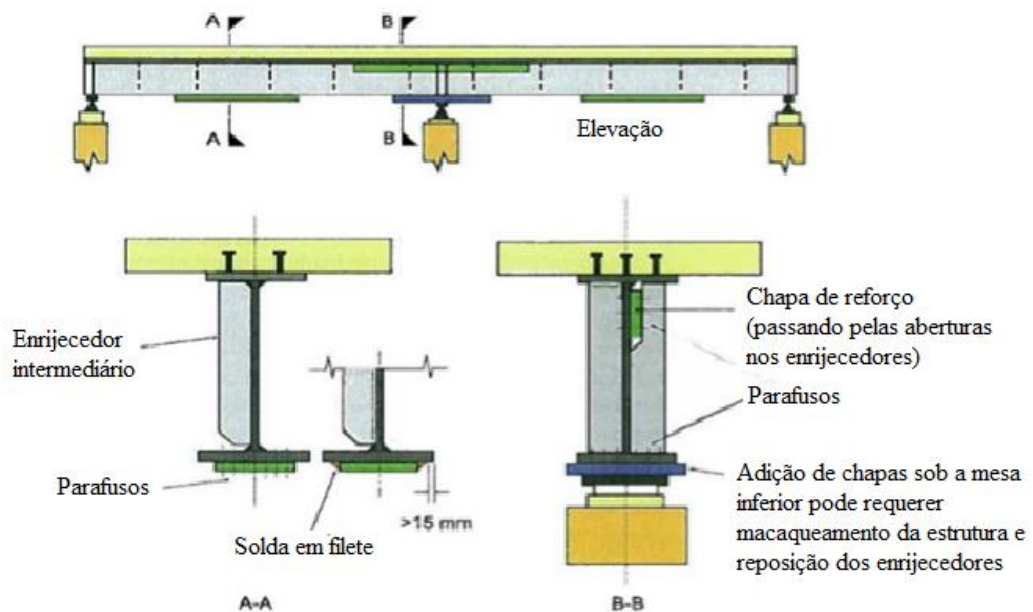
Reforço com chapas soldadas e parafusadas
